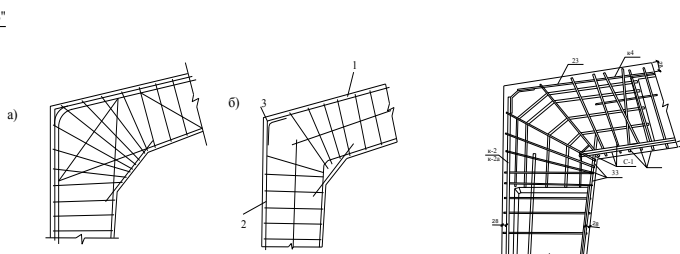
Армування вузла з'єднання ригеля зі стояком: а- гнутими арматурними стержнями; б- за допомогою гнутої закладної деталі; 1,2- арматурний каркас; 3- гнута закладна деталь
